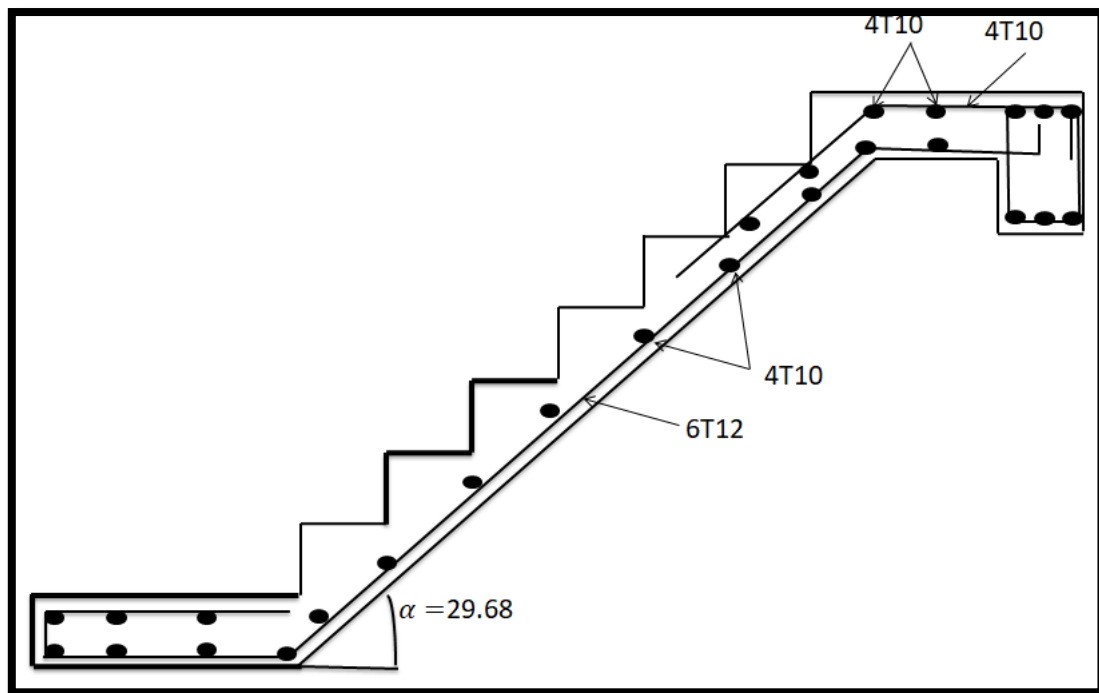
Schéma de ferrailage des escaliers FeE400.
